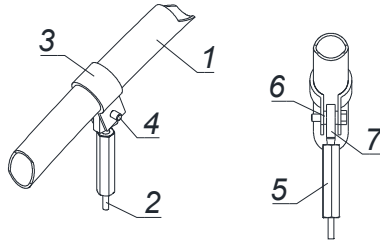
Узел примыкания подвески к арке. 1-арка; 2- подвеска; 3- хомут; 4- палец; 5- талреп; 6- втулка; 7- проушина.
